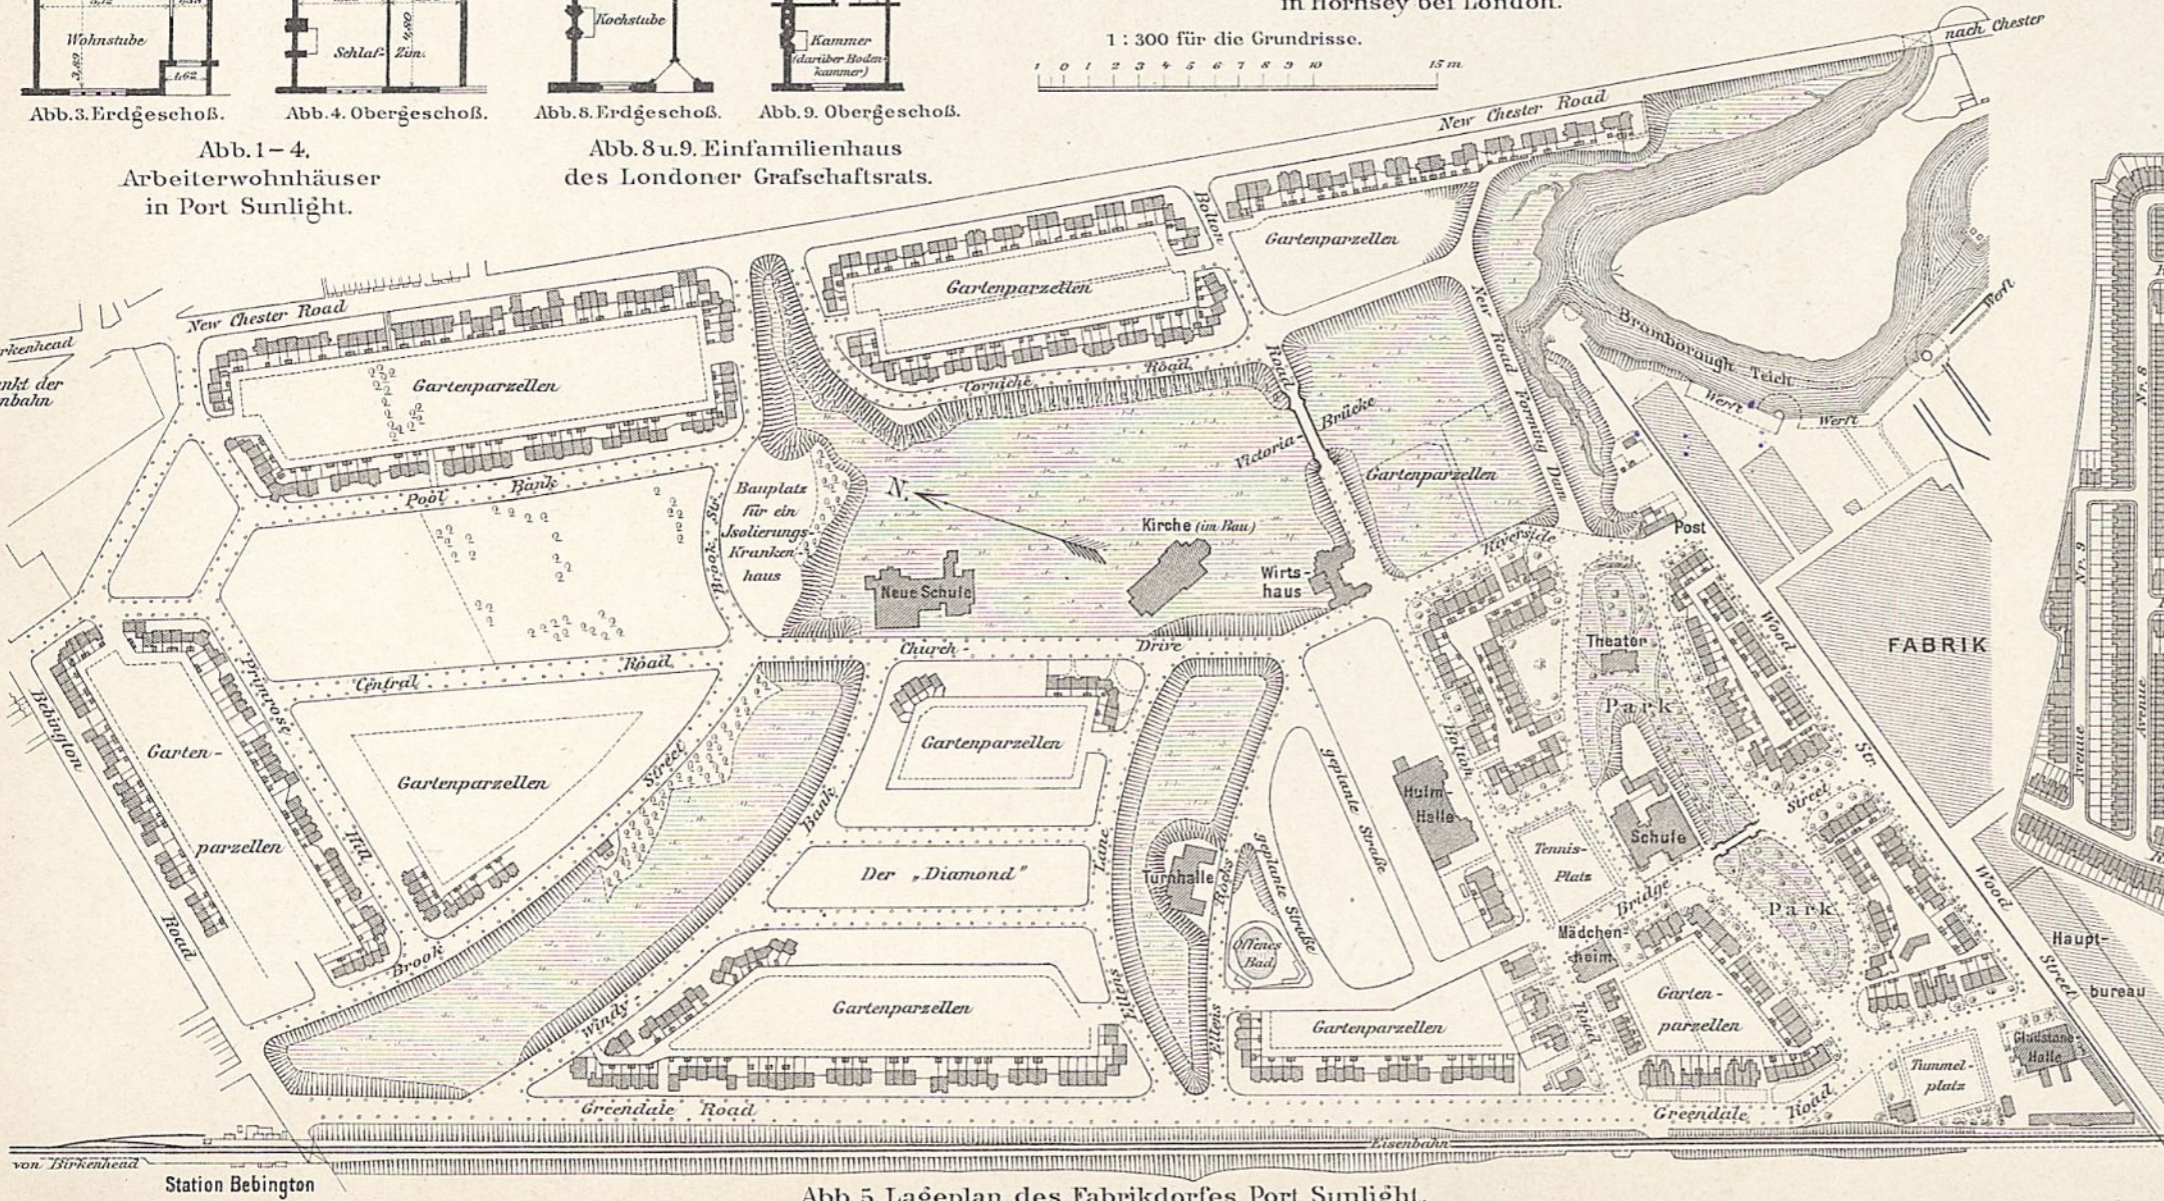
Lageplan des Fabrikdorfes Port Sunlight.
